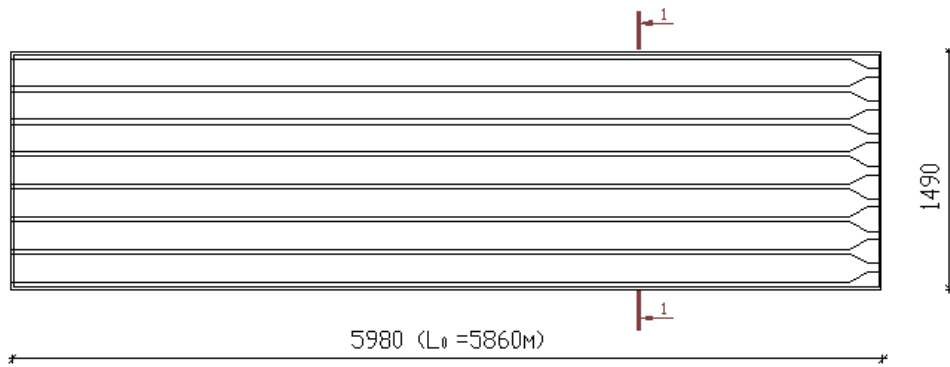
Залізобетонна багатопорожниста панель перекриття.
